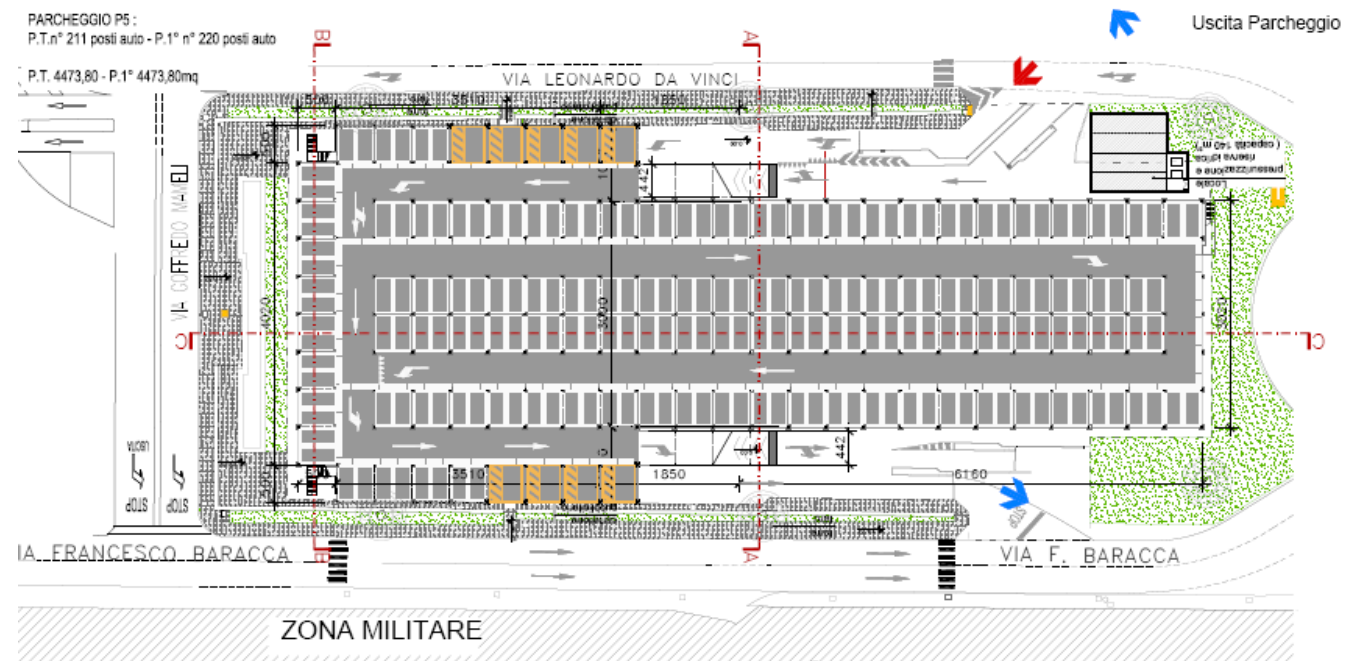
PARCHEGGIO MULTIPIANO MODULARE TIPO FAST PARK P5: PLANIMETRIA
